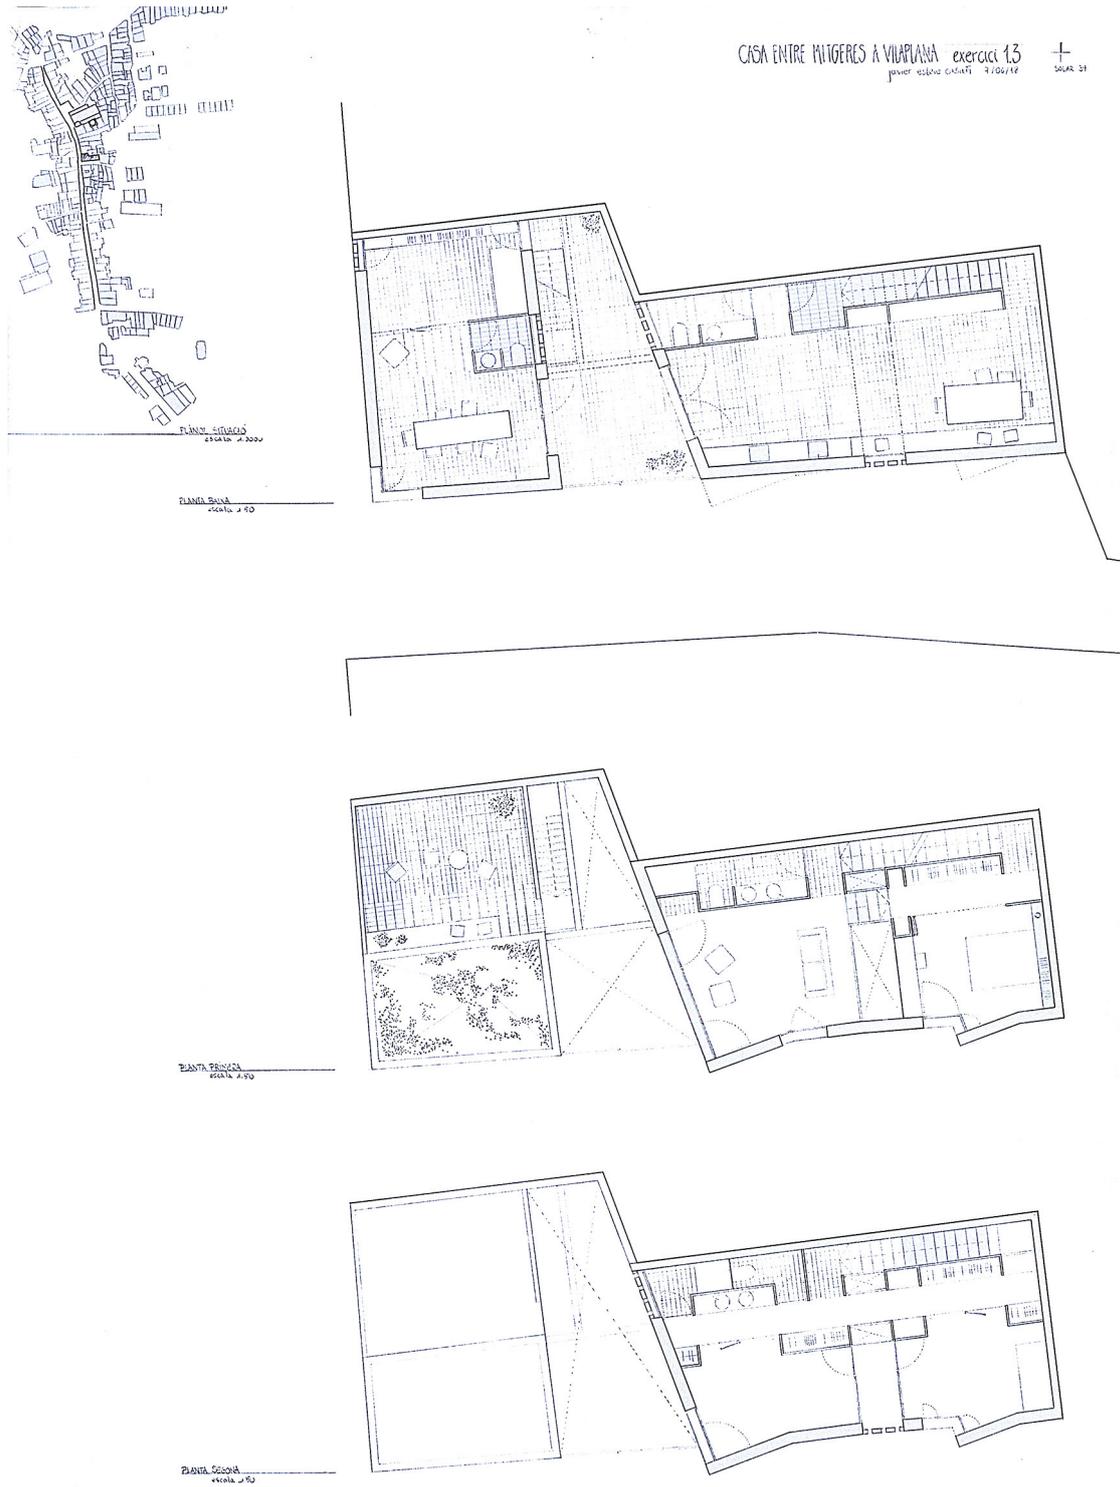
Plantas de distribución, parcela núm.5. Alumno: Javier Esteve
